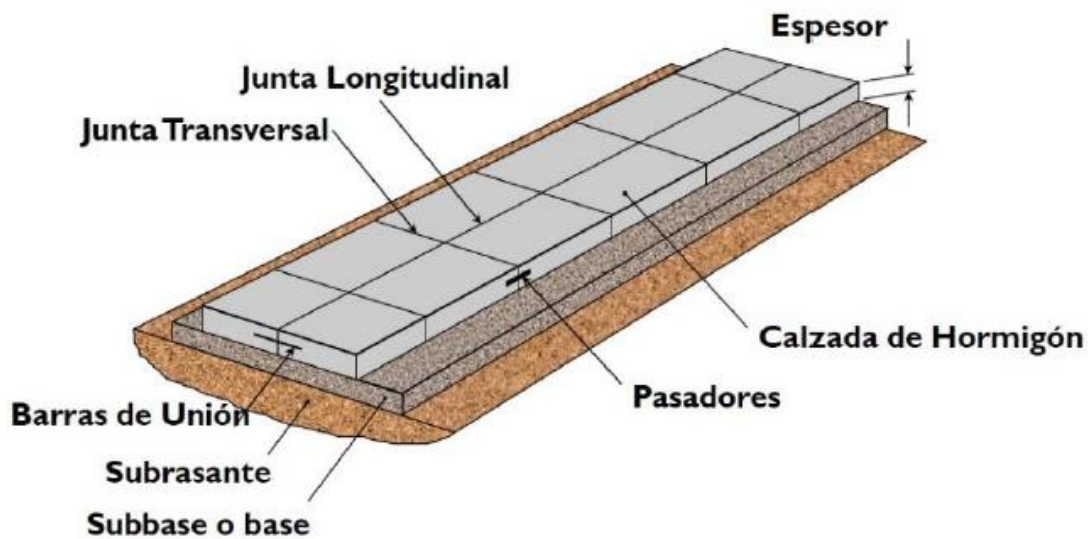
Esquema de juntas en pavimento rígido. Fuente: ICPA
